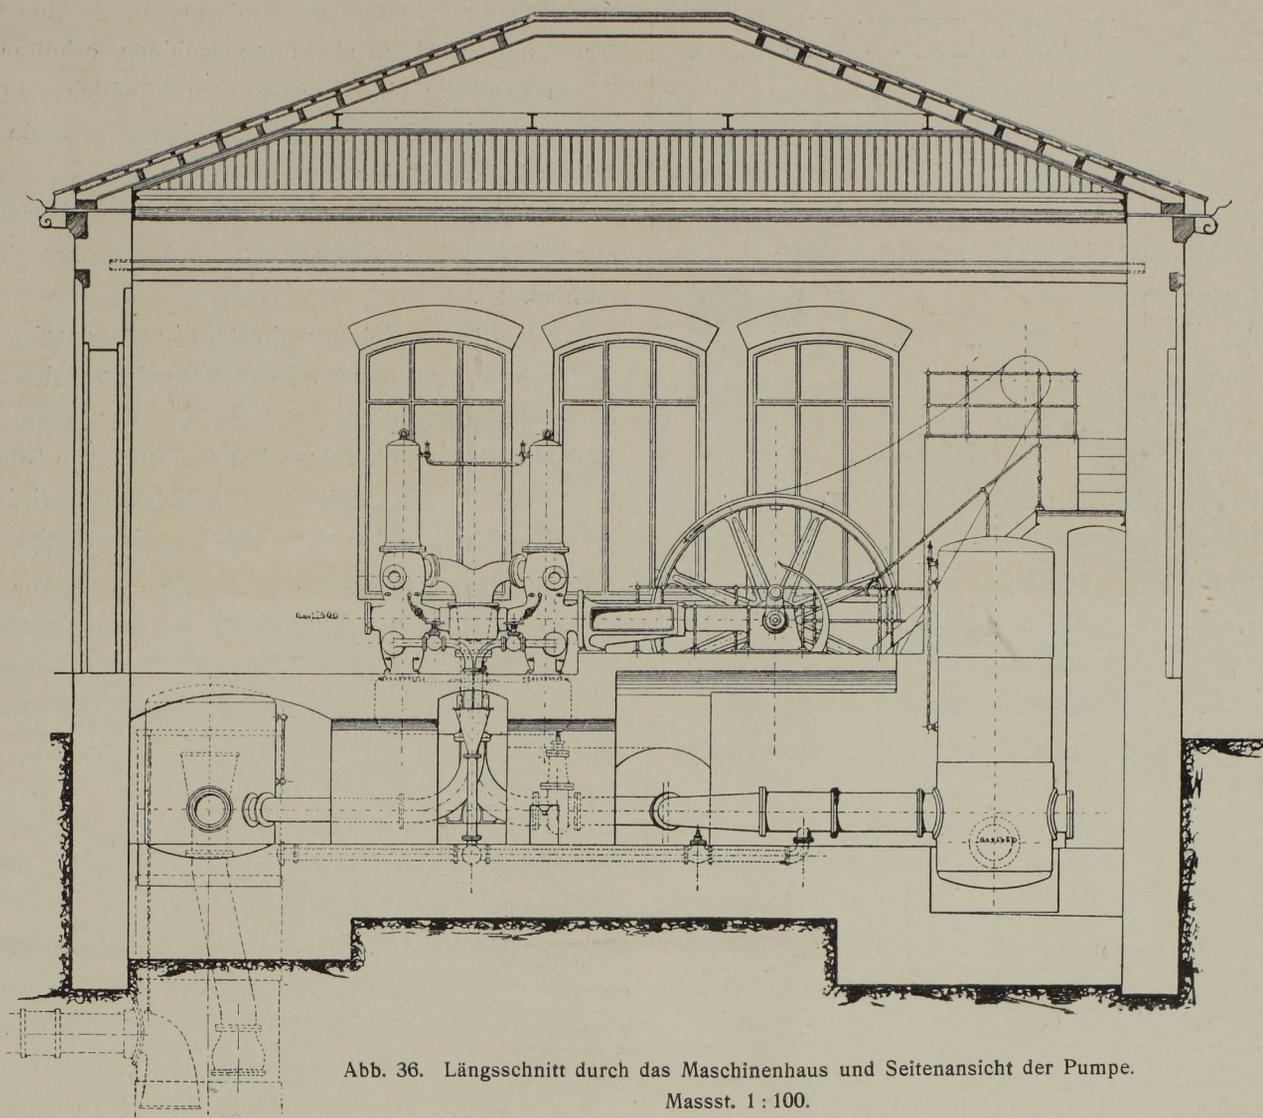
Längsschnitt durch das Maschinenhaus und Seitenansicht der Pumpe.
